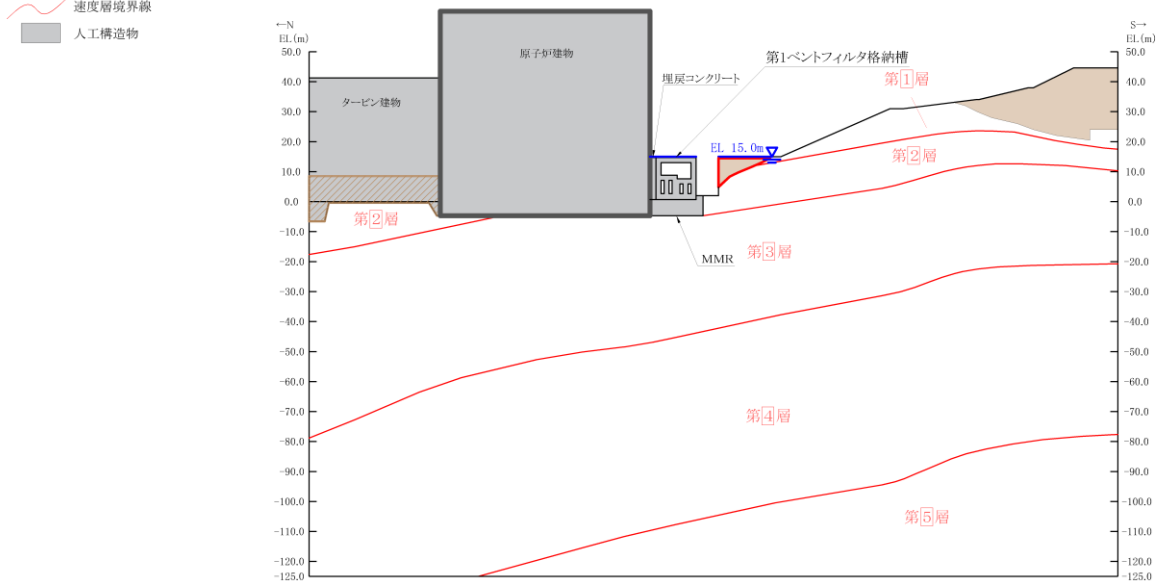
(14) 第1ベントフィルタ格納槽 地質断面図 【B-B断面位置】
